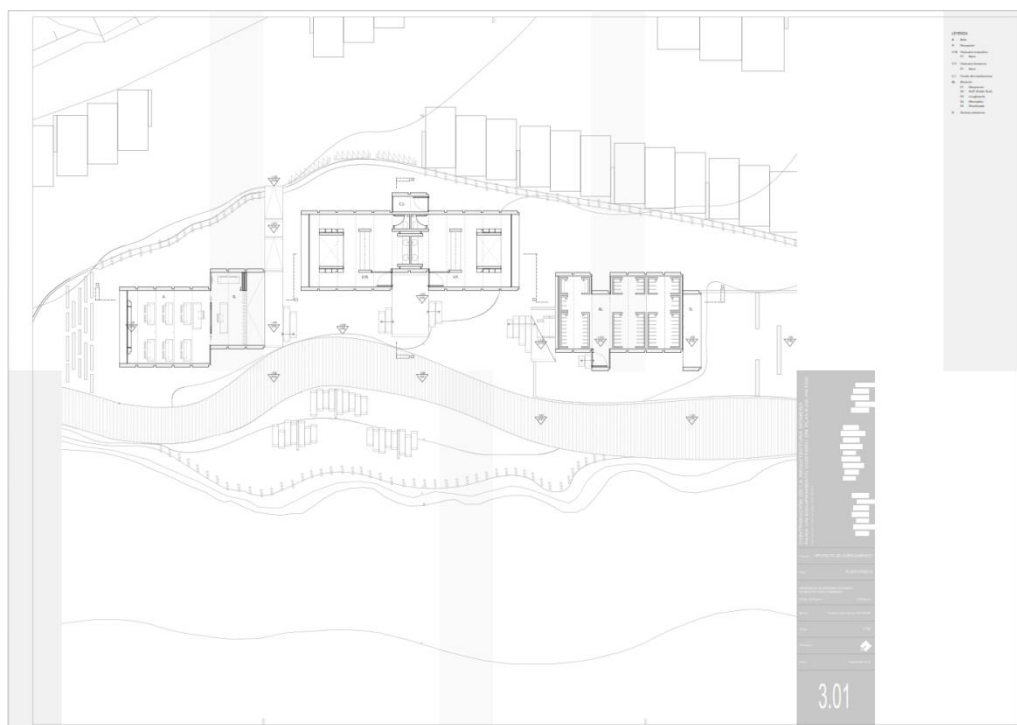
Planta distribución piso 0 de proyecto de disertación
